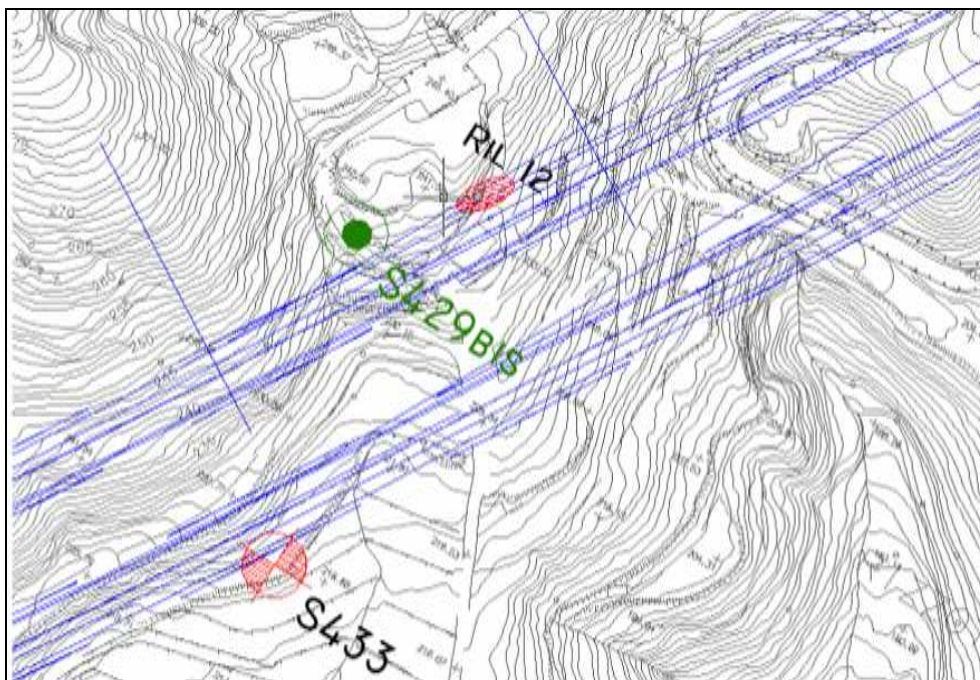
Ubicazione in planimetria dell'affioramento oggetto del rilievo geostrutturale
